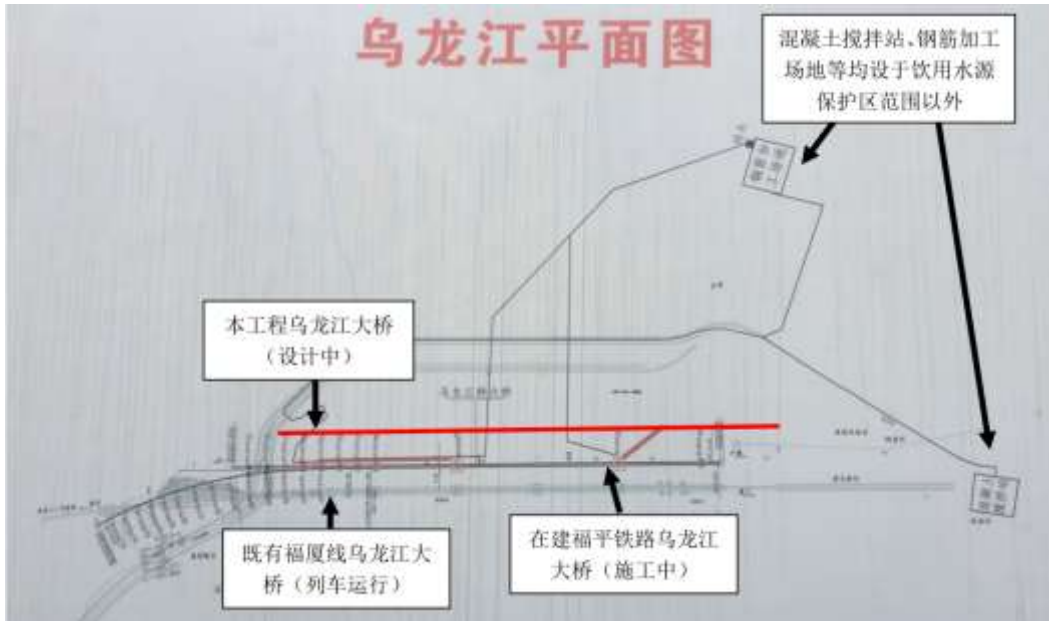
在建福平铁路乌龙江大桥施工平面布置示意图
